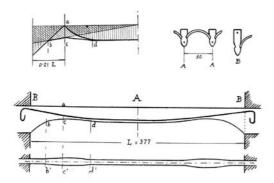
Croquis de la viga de hormigón armado de la portería del Parque Güell. (Bergós Massó 1953)
